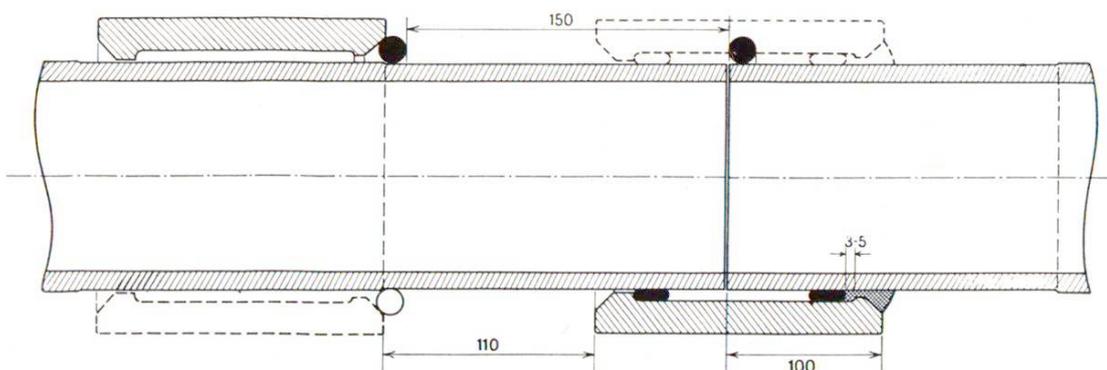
Coupe du joint „Simplex”. On y voit la position du manchon et des anneaux de caoutchouc avant et après le montage. Hachuré croisé, le bouchon de mortier indispensable
